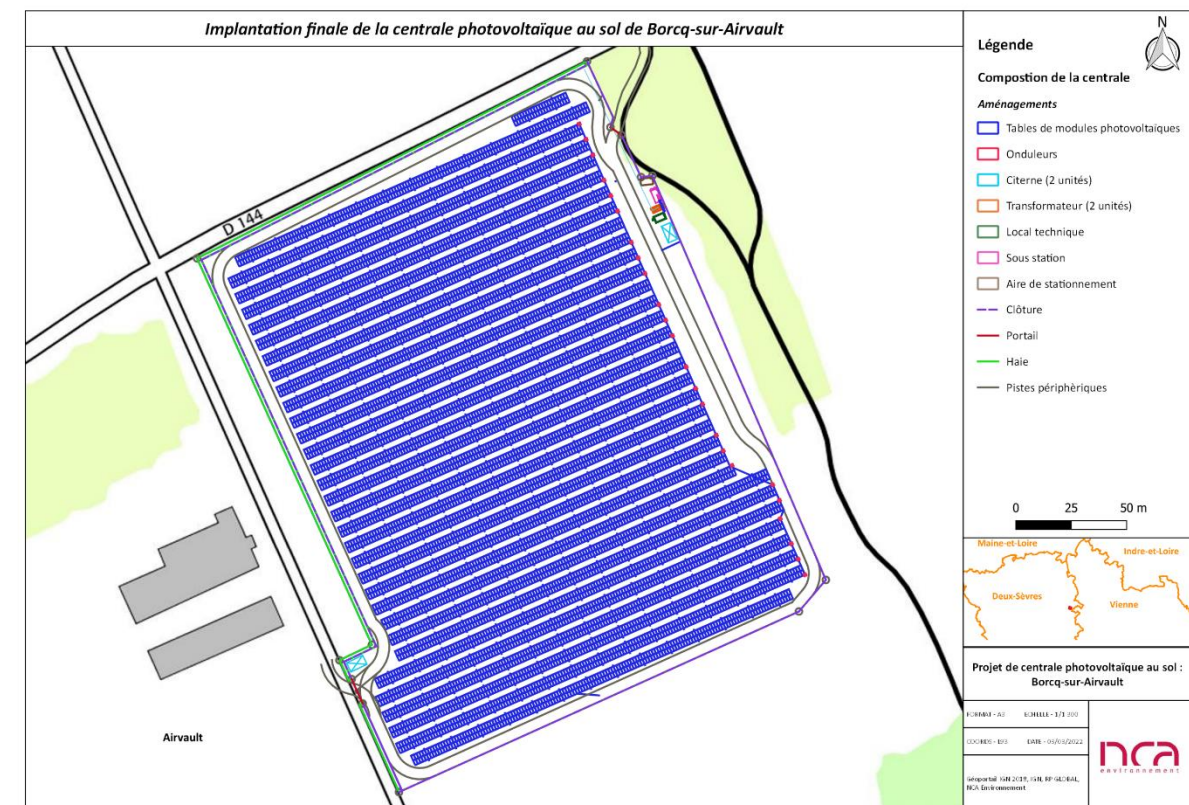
Implantation finale de la centrale de Borcq-sur-Airvault
